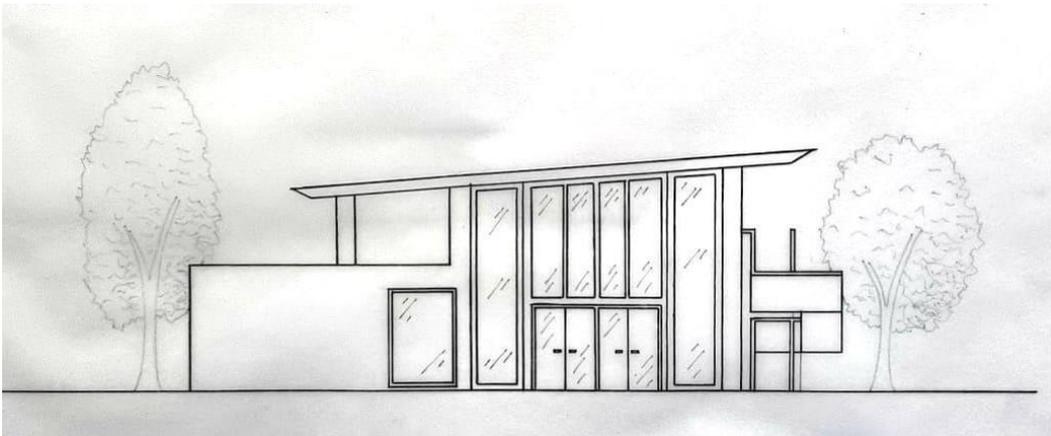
Fachada de ingreso: Materialidad de hormigón armado en su expresión original y el cerramiento vidriado definen la propuesta.
